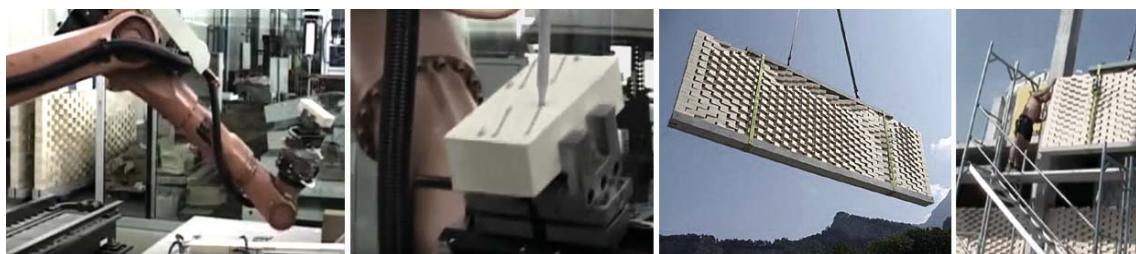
Prefabricación digital y montaje “manual” de la fachada
